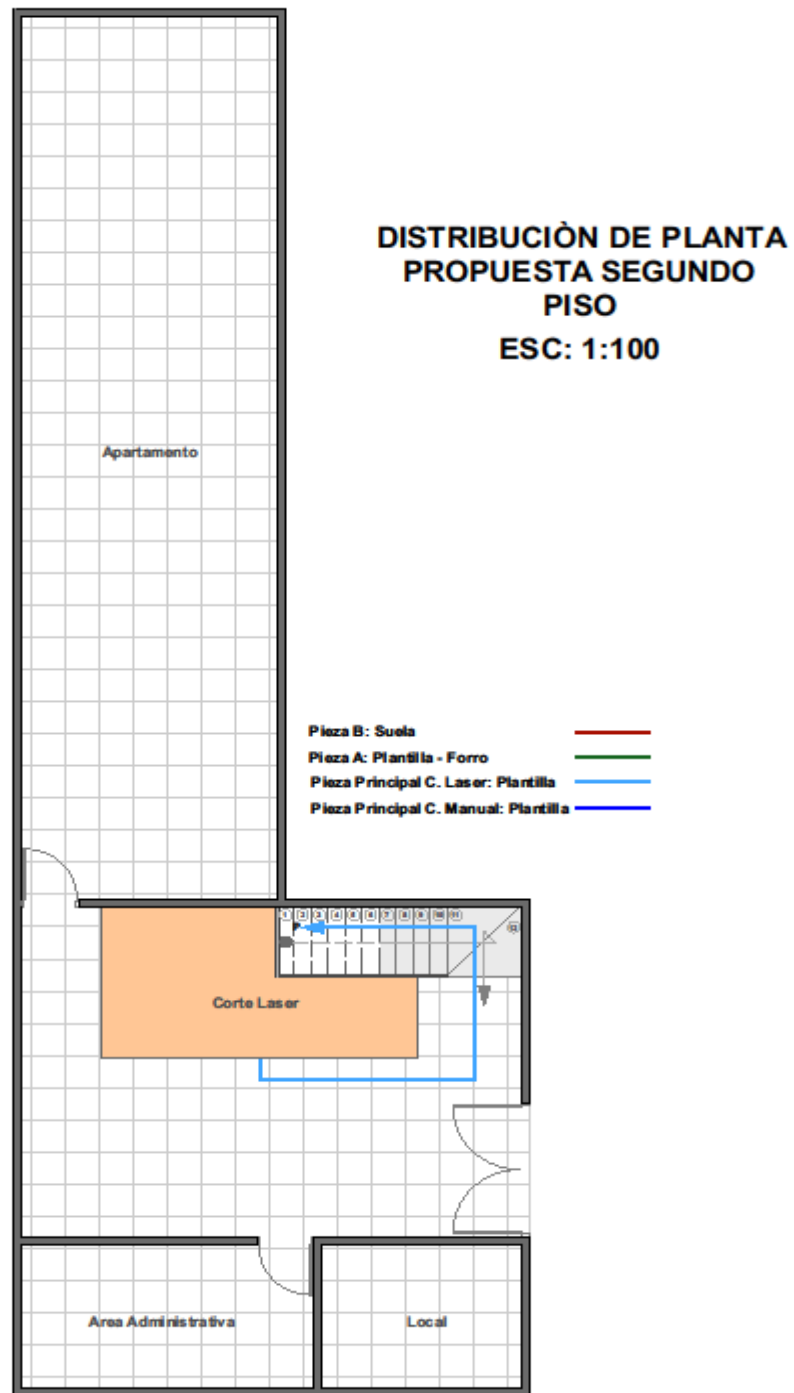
Distribución de planta propuesta segundo piso calzado D´Lady y Fashion Women
